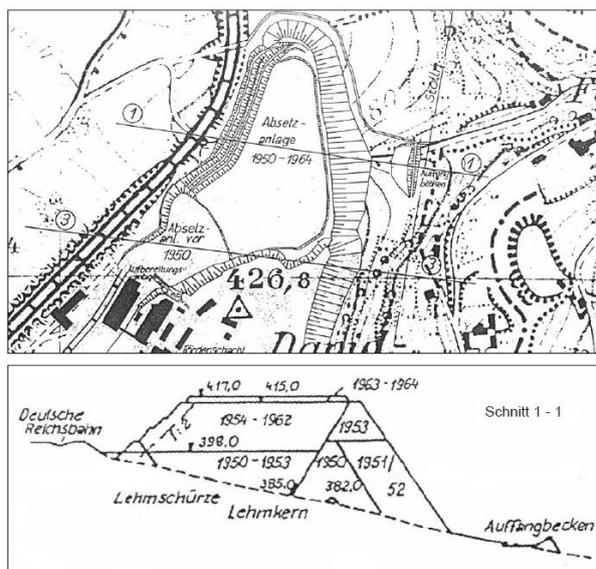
Lageplan und Schnittdarstellung der Spülhalde Davidschacht (aus: IBUR 1995, HE).
